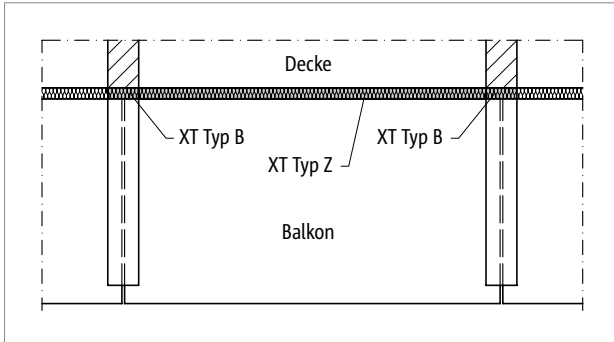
Schöck Isokorb® XT Typ B: Balkonkonstruktion mit frei auskragenden Unterzügen (Fertigteilbalkon)
